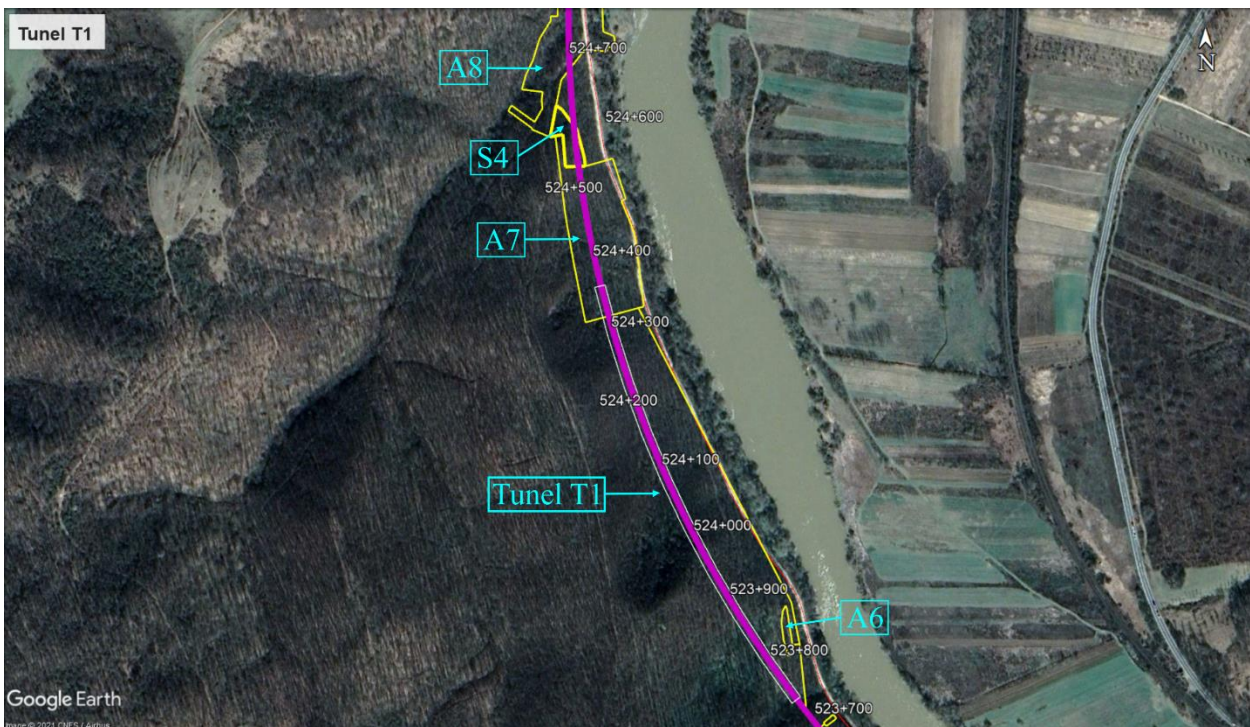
Plan de amplasament al Tunelului T1, jud. Hunedoara – vedere din satelit
